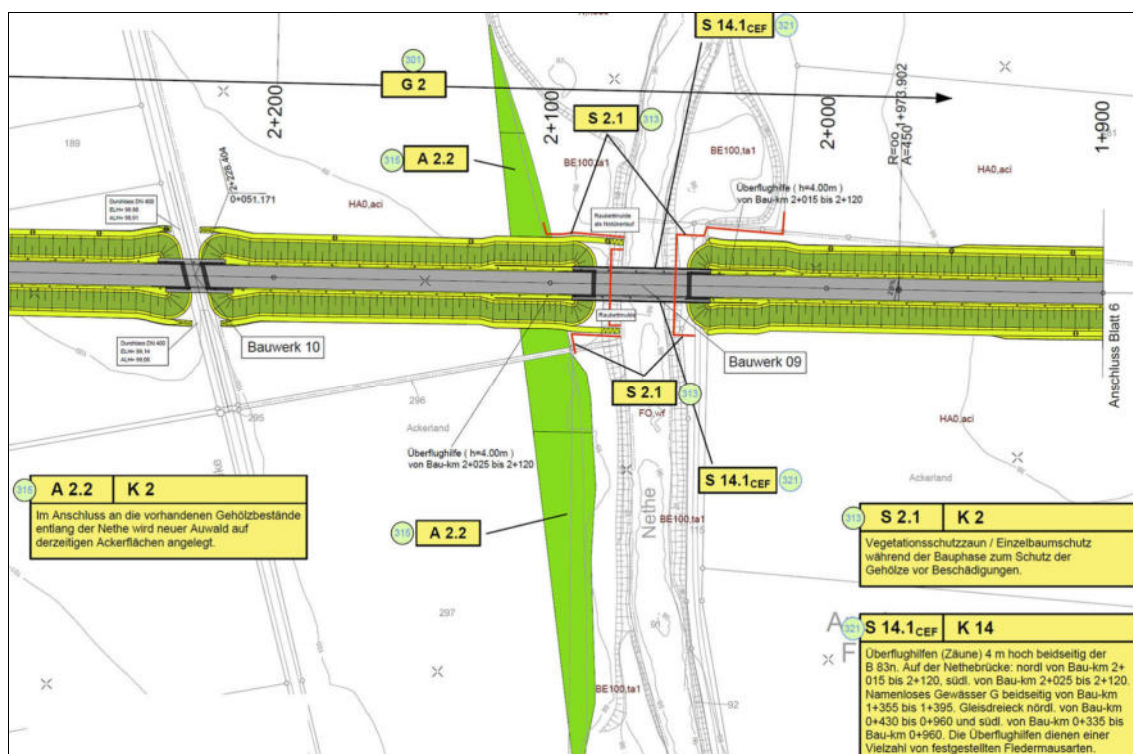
Ausschnitt aus dem Maßnahmenlageplan des LBP zu Struktur 4 (Nethe)
